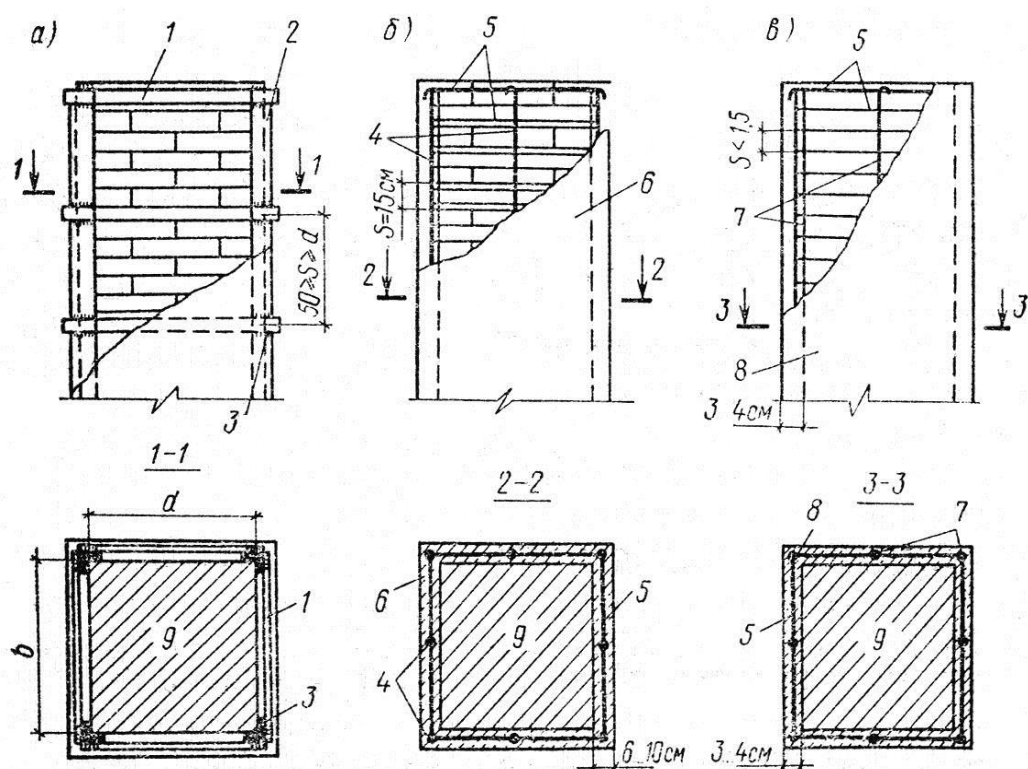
Усиление каменных столбов стальной (а), железобетонной (б) и армированной раствором (в) обоймами:
